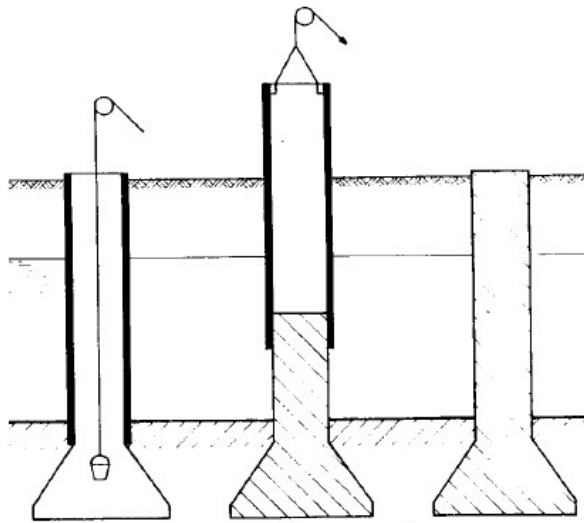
Fundação profunda do tipo tubulão. Fonte: Barros (1996)
